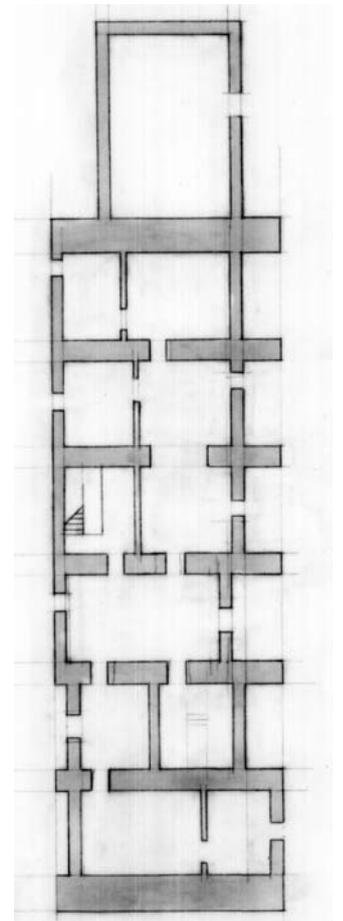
Masseria dell'Assunta - Planimetria primo livello
